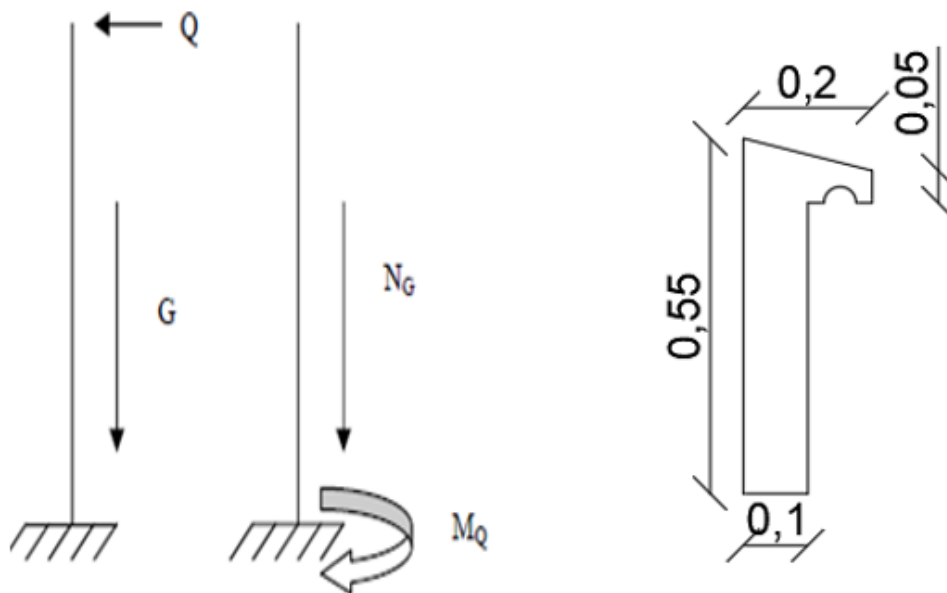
Coupe transversal de l'acrotère et Schéma statique de l'acrotère.
